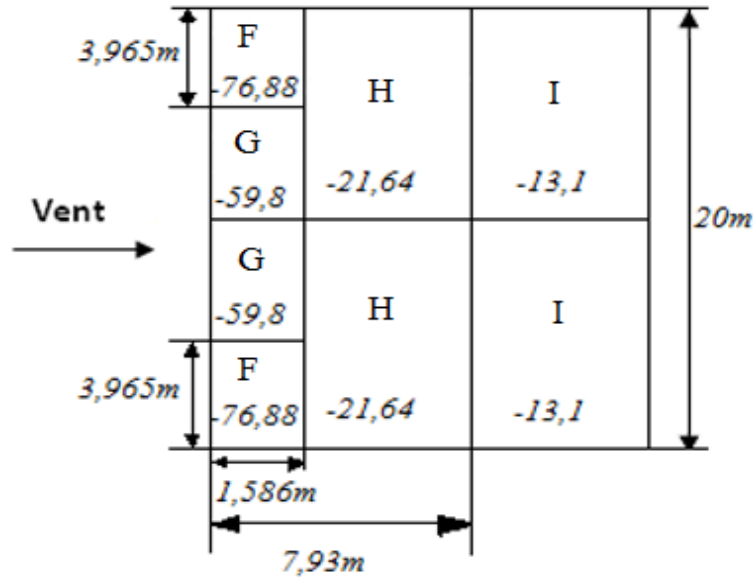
Pression statique du vent q_j sur la toiture (vent sur pignons 1 ; 2)
